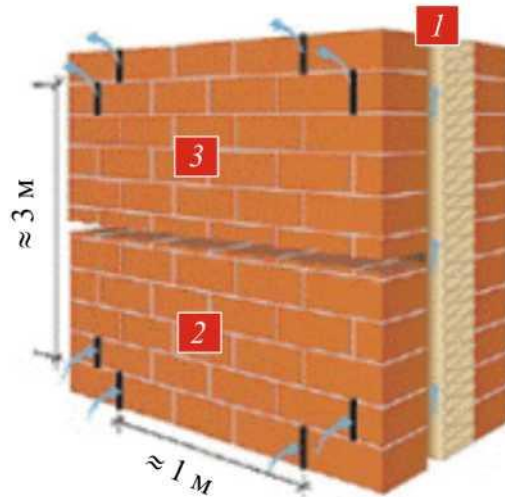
Схема пристрою шаруватої кладки із зазором:
